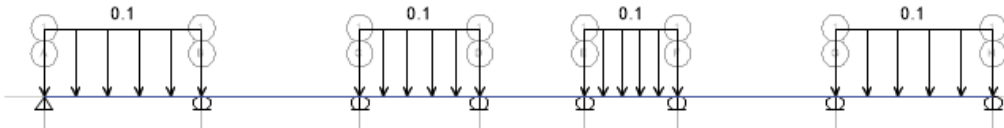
Carga viva distribuida en vigueta de losa aligerada – Damero 1
